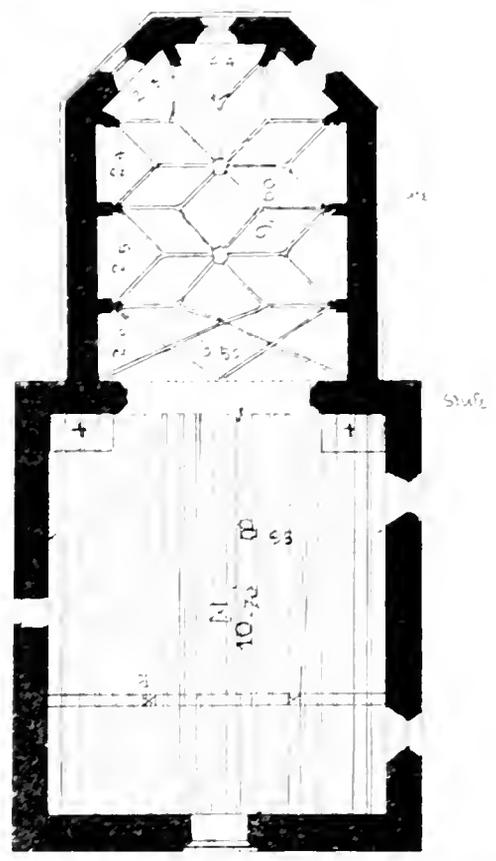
St. Leonhard in der Schlanitzten. Grundriss.
